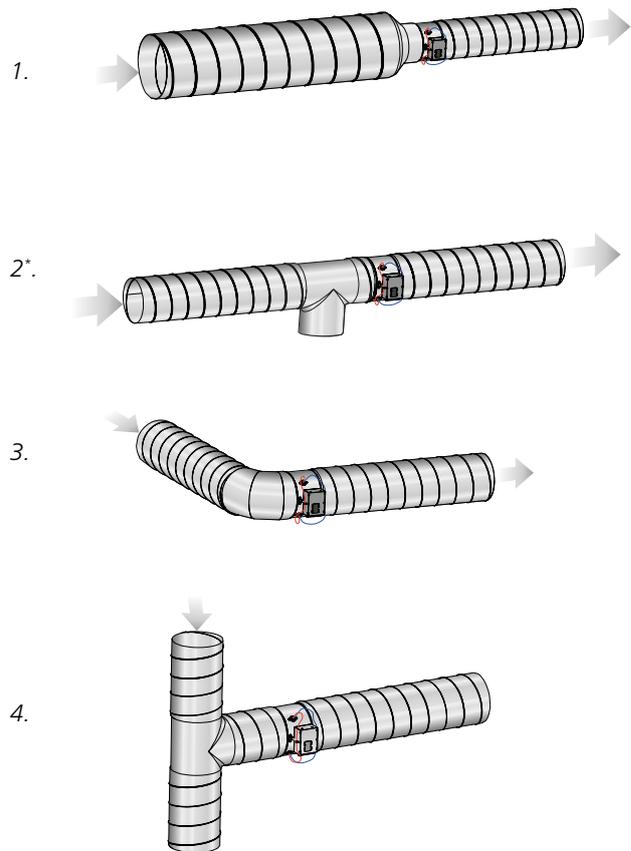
Sections droites requises pour installation sur gaine circulaire.
